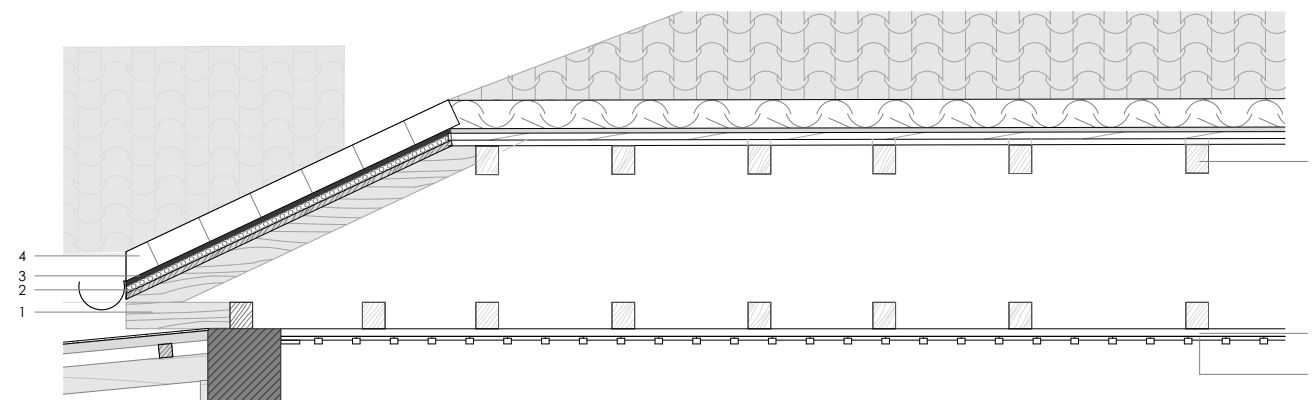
Detalle constructivo 30 | Estado actual cielo raso, espacio: dormitorio.
